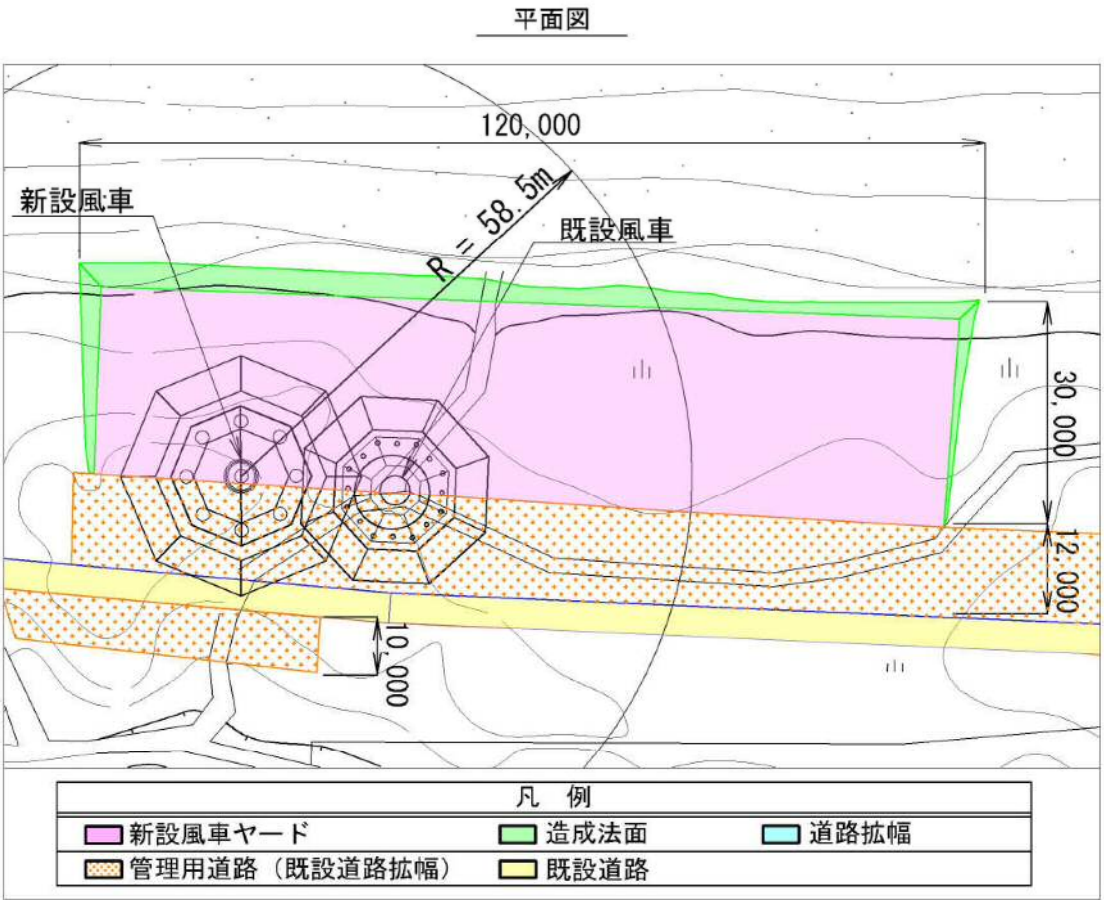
(1) 造成平面・横断計画図（新設 1 号機）
